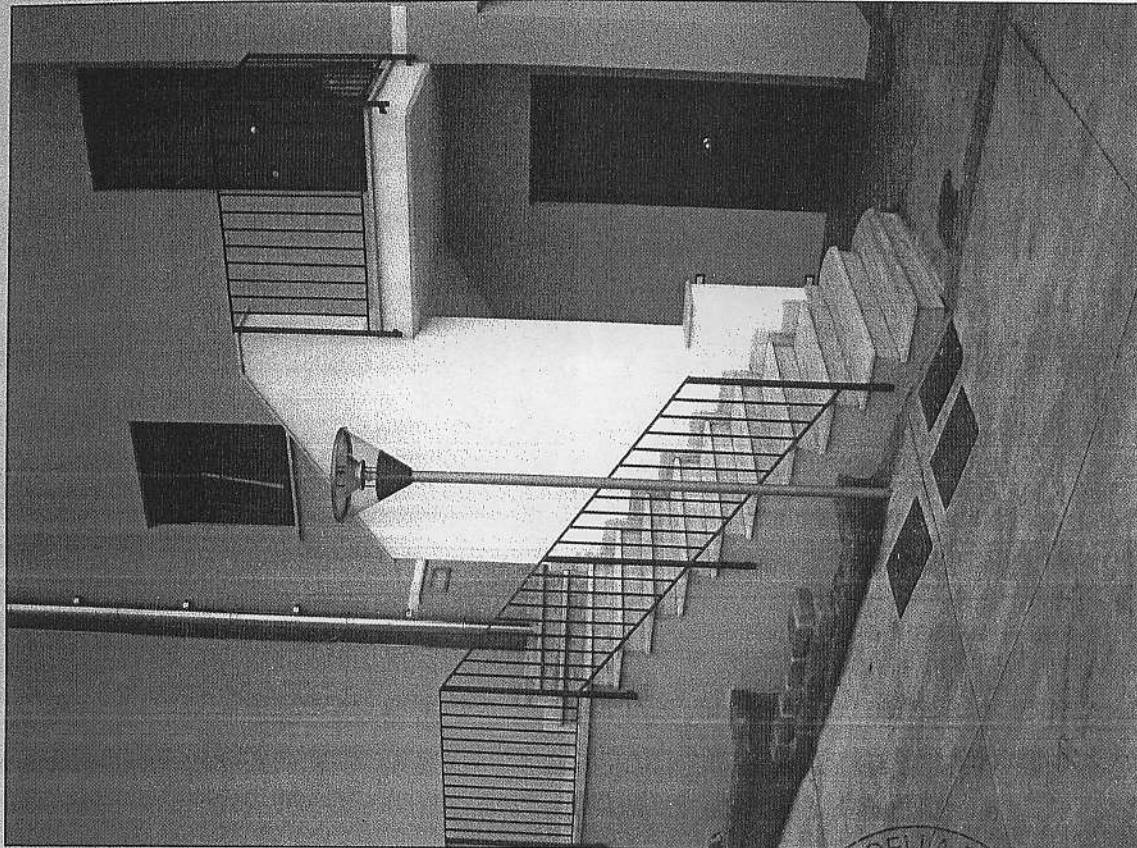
Palo a singolo corpo illuminante dell'impianto di illuminazione esterna
